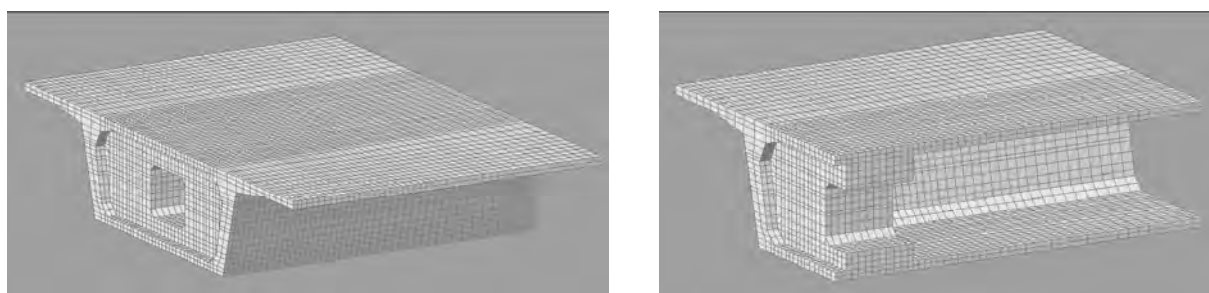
Biểu đồ thiết kế dầm ngang
